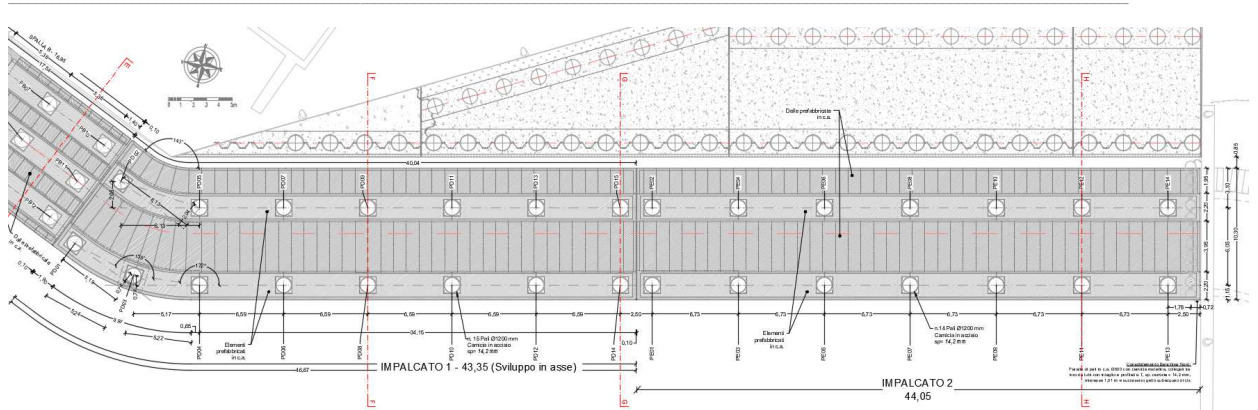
Planimetria della viabilità su pali (Impalcati 1 e 2)
